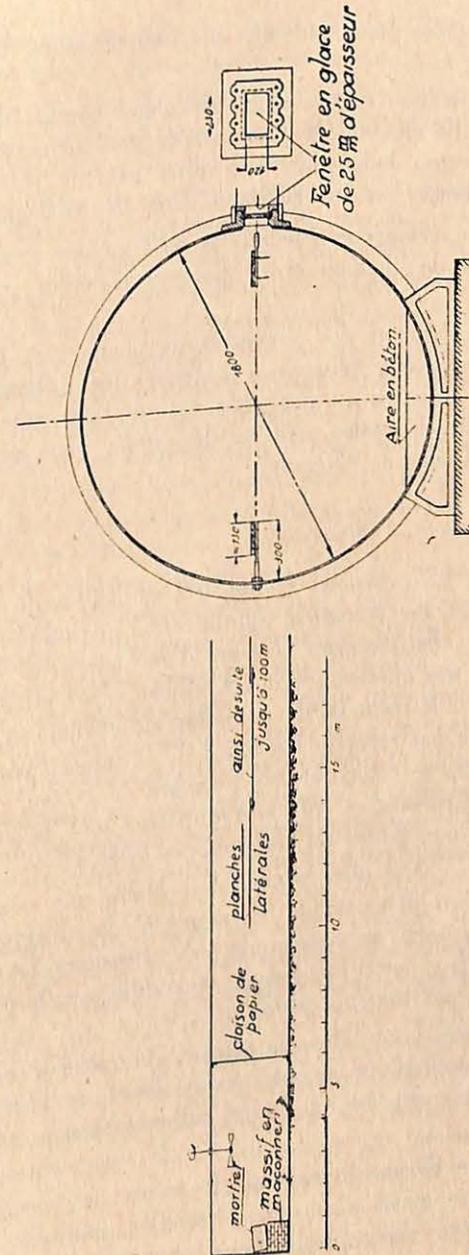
Coupes (à échelles différentes) de la galerie d'essai. A gauche : coupe longitudinale de la partie voisine du mortier; à droite : coupe transversale de la galerie.
